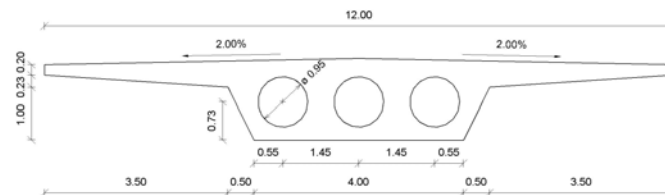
Sección transversal en Revit de un puente losa con aligeramientos circulares.
